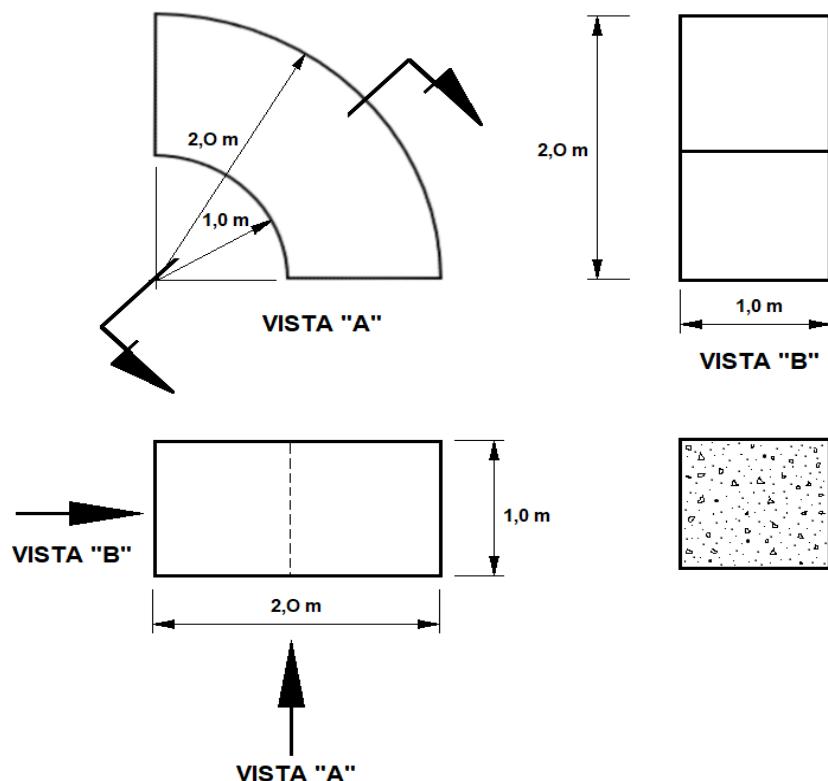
Desenho técnico de um semi-arco de pedra com vistas e corte. Escala reduzida 1: 50 (cm).
